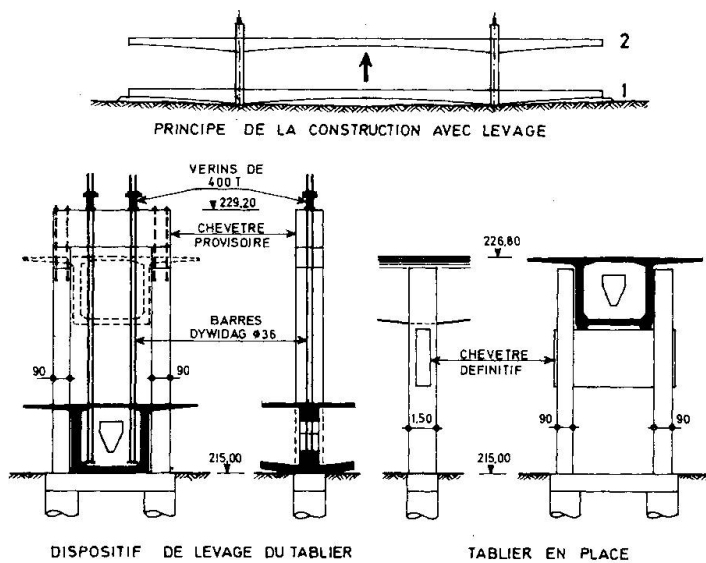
Levage d'un tablier (projet Dragages et Travaux Publics)
